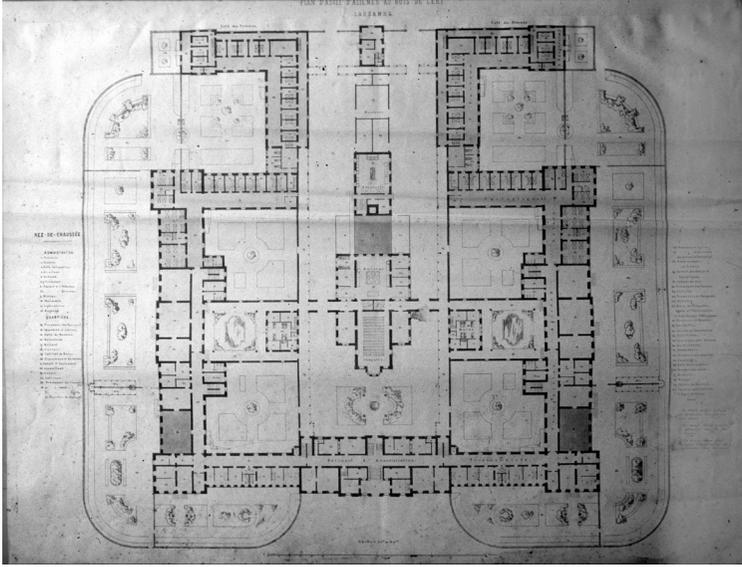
Cery, Asile d'aliénés (1867-1873), plan du rez-de-chaussée (ACV).
